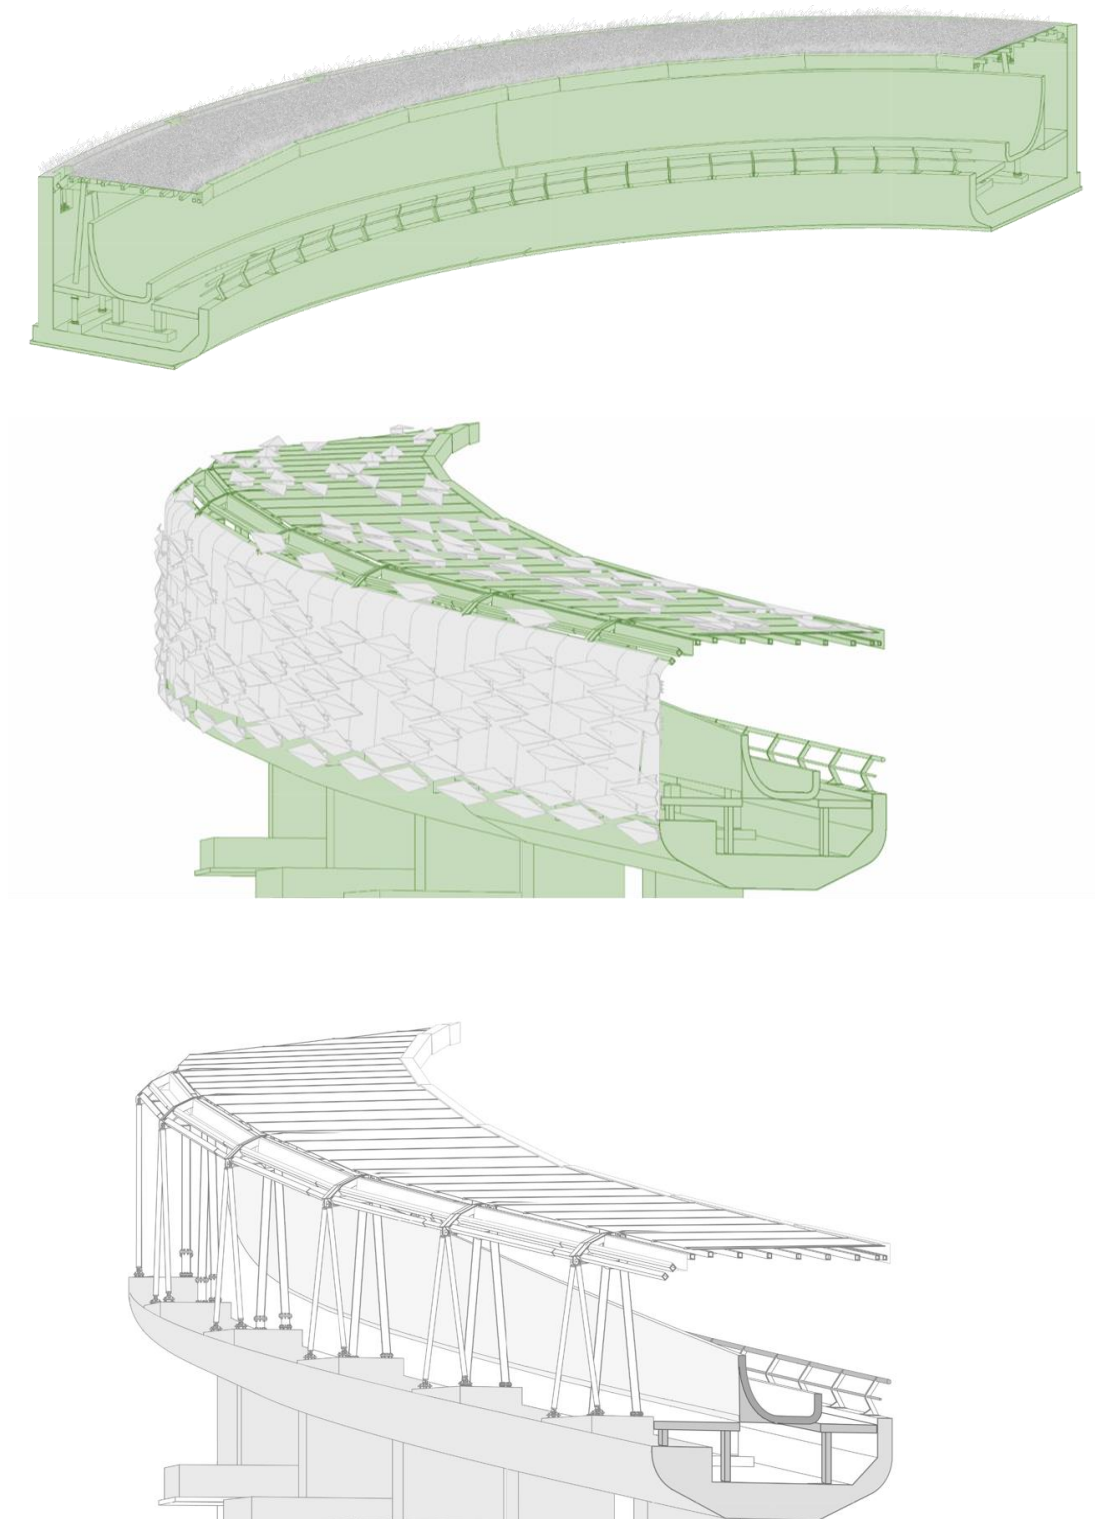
Nell’immagine in alto e centrale vista della sezione semi-ipogea ed appoggiata come da PE originario, con evidenziati in verde i corpi d’opera confermati. In basso. Vista della sezione appoggiata-in elevazione nell’aggiornamento del progetto
